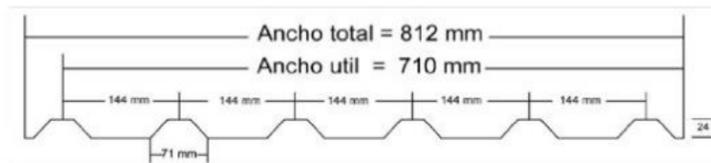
Detalle de instalación de lamina troquelada para cubierta de techo. Extraído de: <https://www.indenicsa.com/lamina-estructural-prepintada-e-76/>
